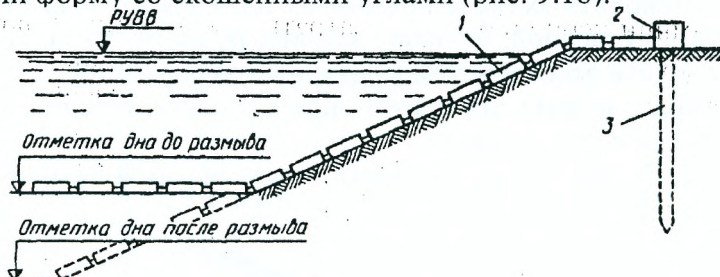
Укрепление откоса гибким покрытием из бетонных плит: 1 – гибкое покрытие, 2 – бетонный упор; 3 – железобетонная свая
